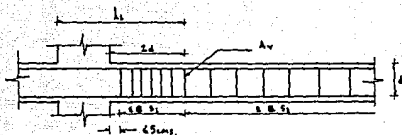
Requisitos para refuerzo longitudinal en vigas de concreto ($Q=4$).
